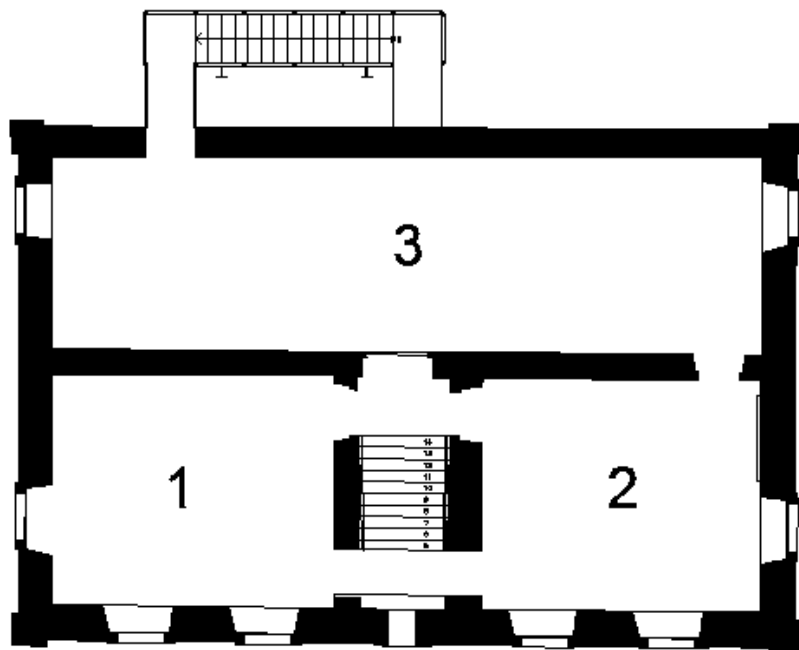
Proposta de planta para o Pavimento Superior (1. Sala da Civilização Indígena; 2. Sala dos Navegadores; 3. Sala do Encontro).
